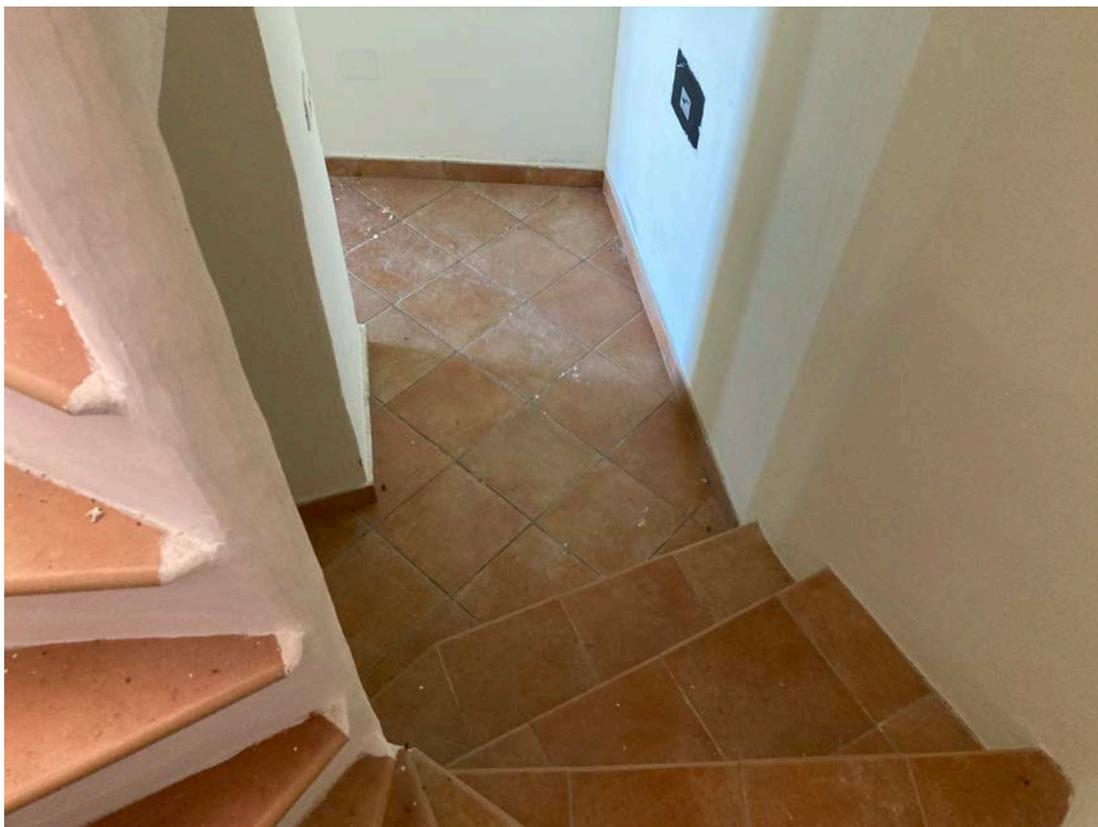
particolare scala a chiocciola interna in arrivo al Piano Terra
